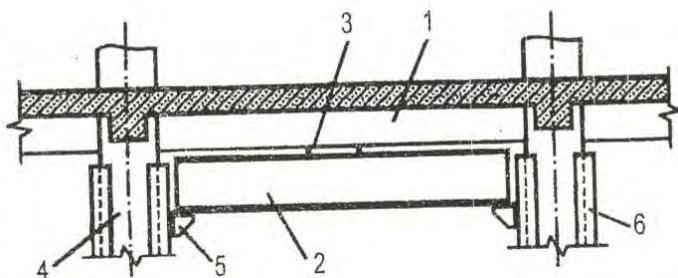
Усиление частичным разгрузением конструкции (дополнительная упругая опора – балкой на кронштейнах): 1 – усиливаемая балка; 2 – усиливающая балка; 3 – подклинка; 4 – колонна; 5 – опорный кронштейн; 6 – металлическая обойма
